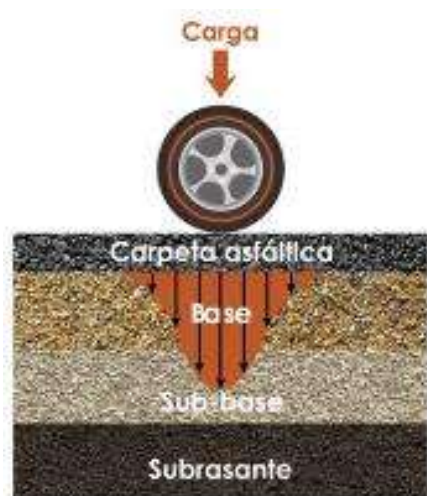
Capas del pavimento asfáltico (Fuente: Udocz)
